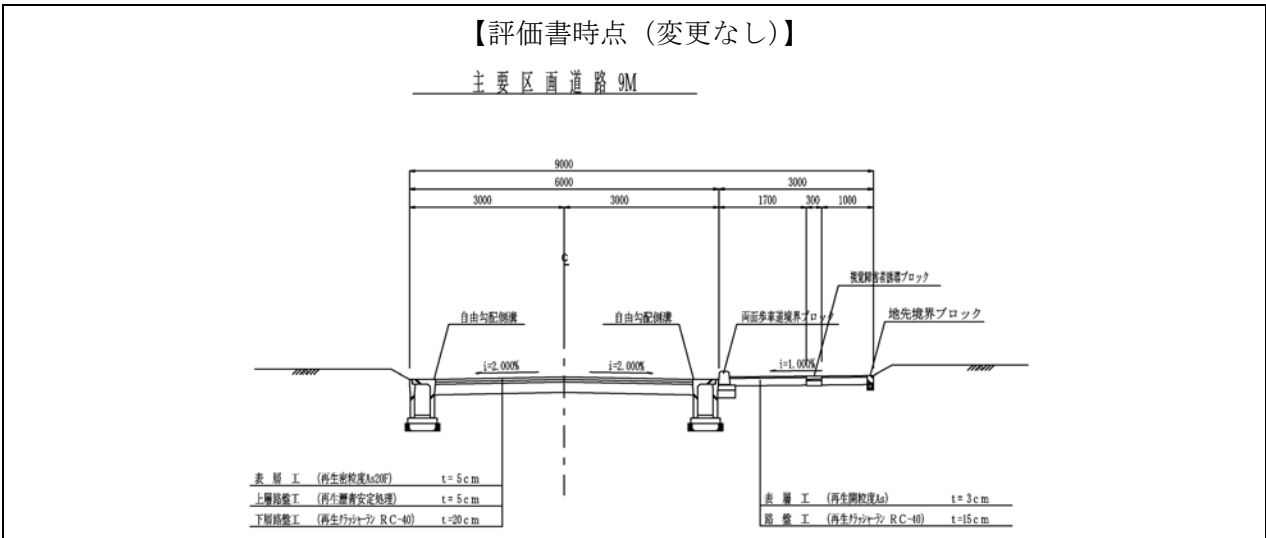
(5) 道路断面図(主要区画道路:9m 標準断面)
